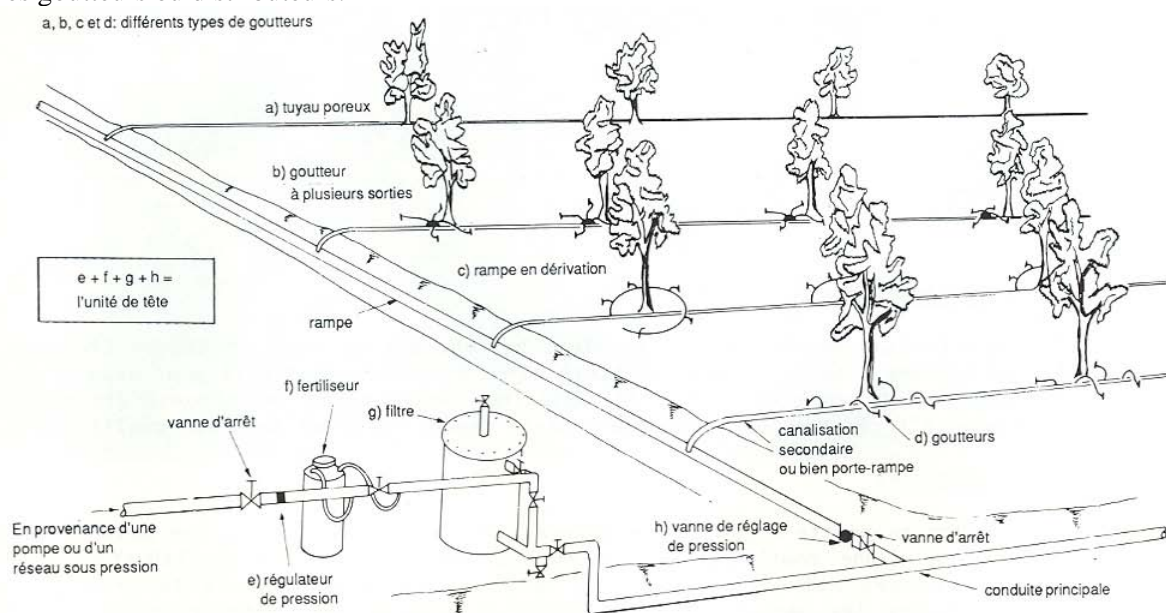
Schéma type d'une installation d'irrigation au goutte à goutte
